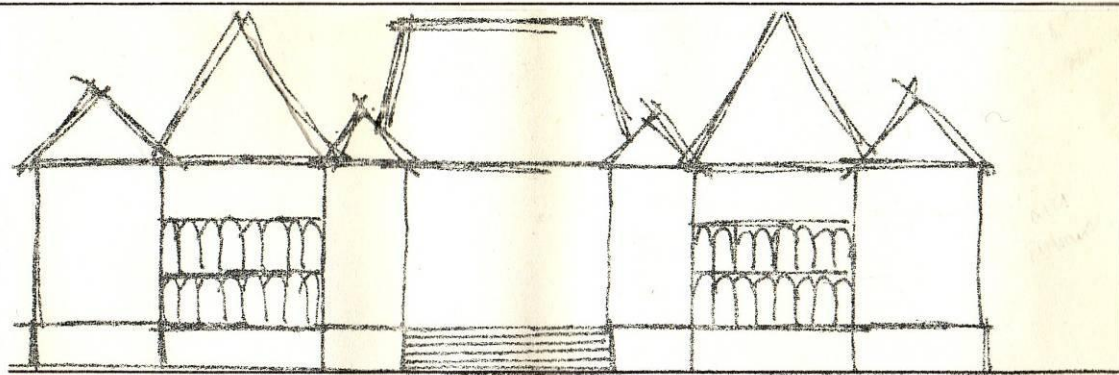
/414 : Elevation schématique du Château dit "de Madrid".
